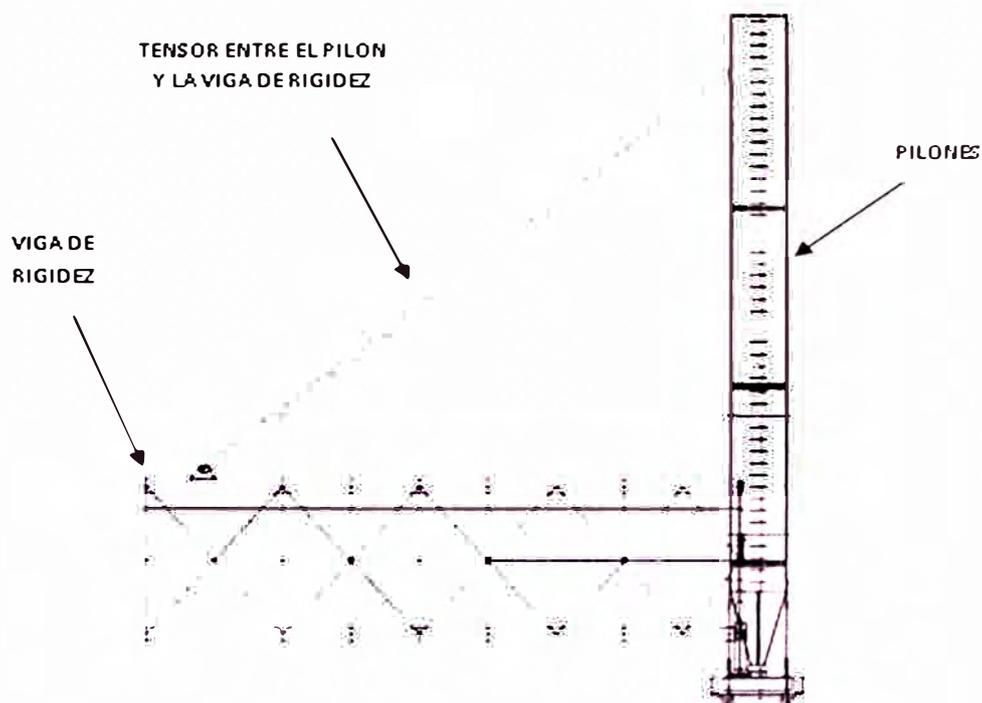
ESQUEMA DE TENSOR ENTRE VIGA DE RIGIDEZ Y
